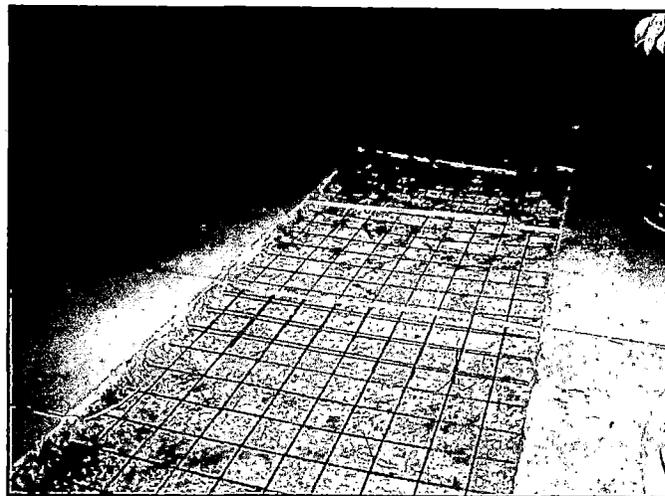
Reforzamiento de una losa con malla electrosoldada
